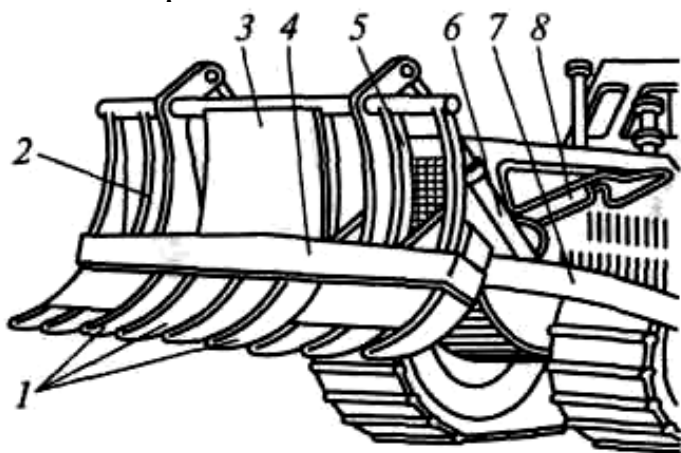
Корчеватель-собиратель МП-7А:
